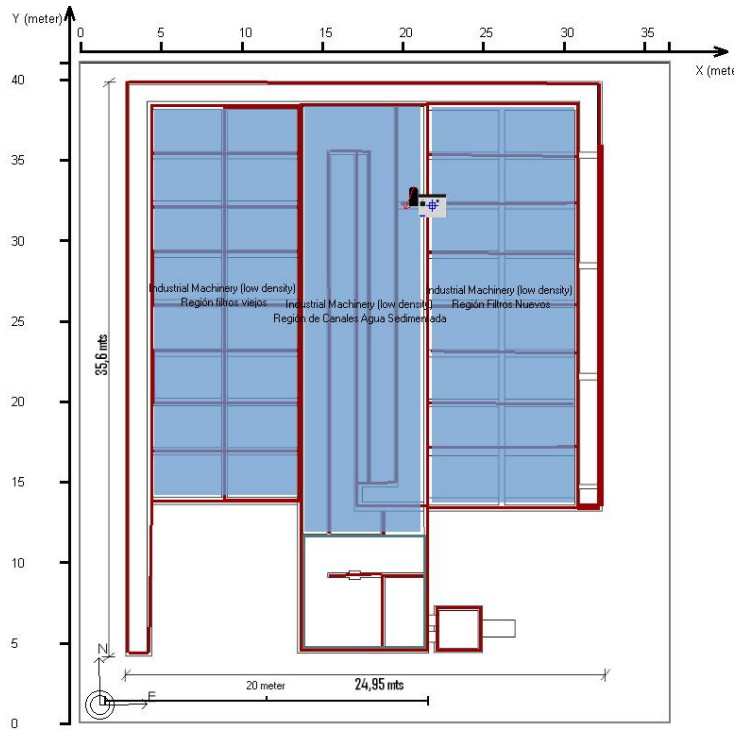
Floor Plan - Planta El Tablazo - Planta tratamiento químico
